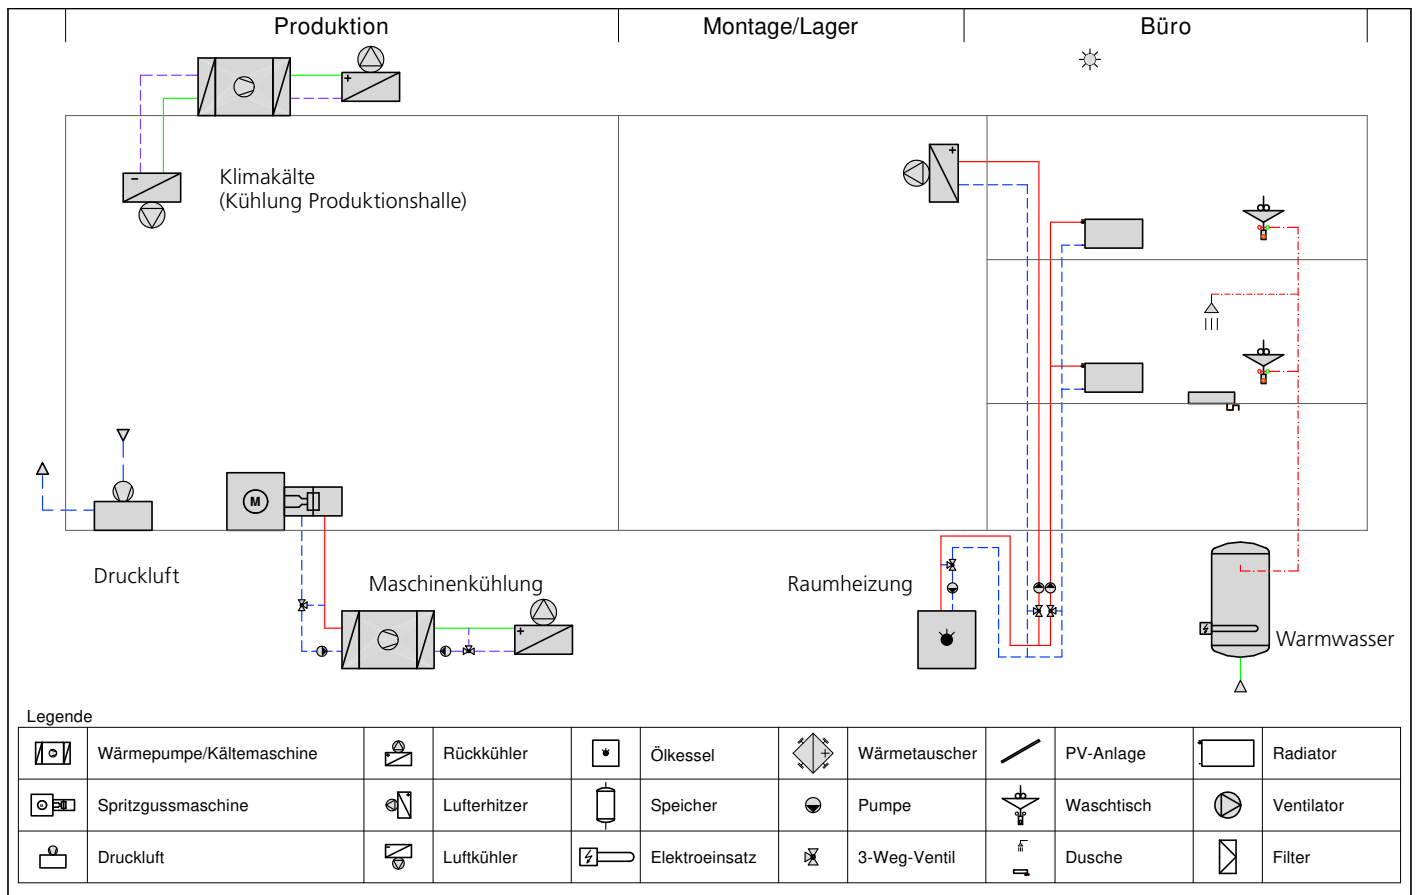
, Typische Situation in einem Kunststoffbetrieb (Musterbetrieb mit energierelevanten Anlagen)
